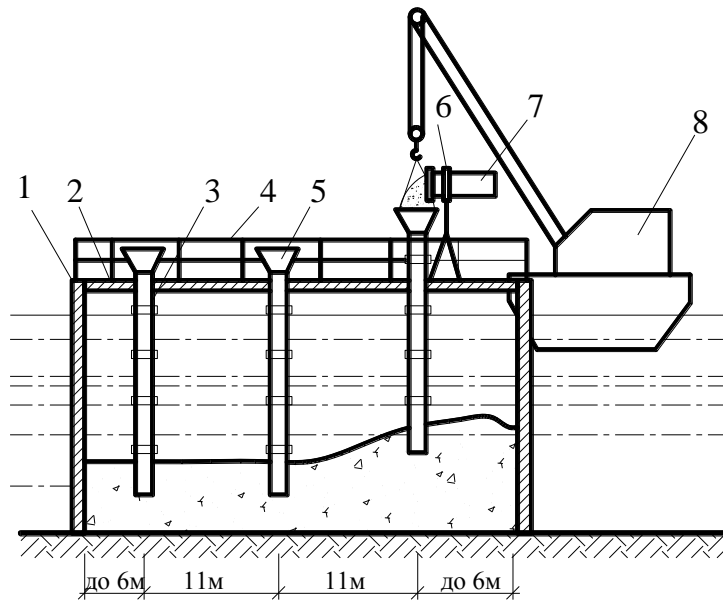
Підводне бетонування методом вертикального підйому труб:
